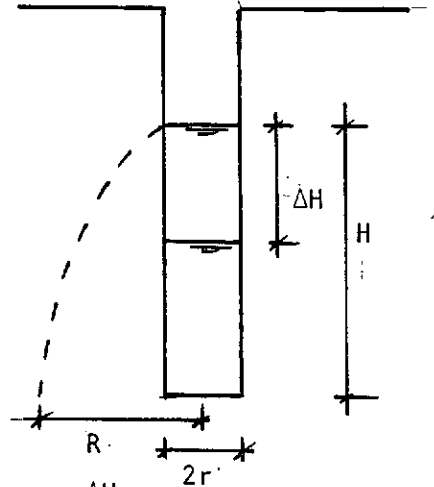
Ensaio de bombeamento em poços de prospecção
